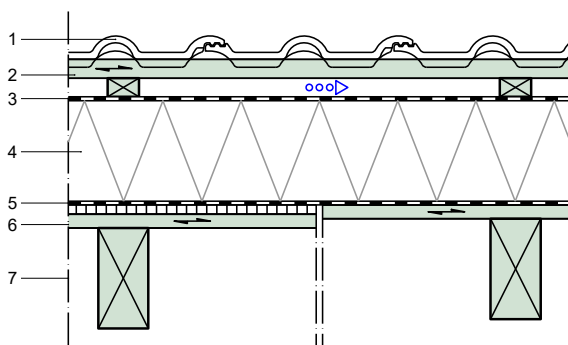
Dachaufbau mit Aufdachdämmung GK 0
